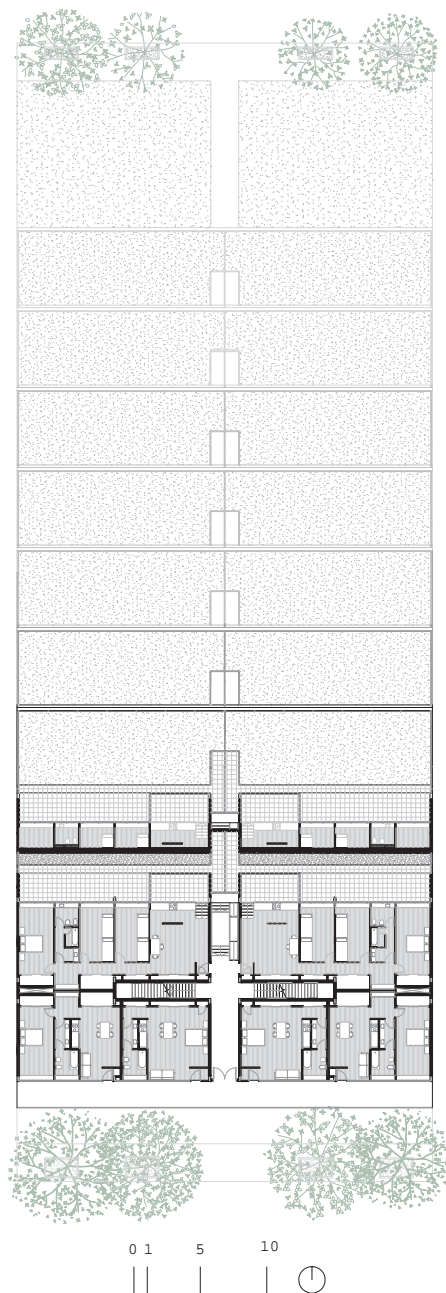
Planta cota 9,70m del módulo de viviendas de un bloc
